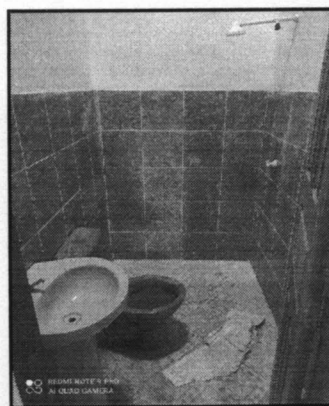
Imagem do Banheiro, com piso e revestimento cerâmico
